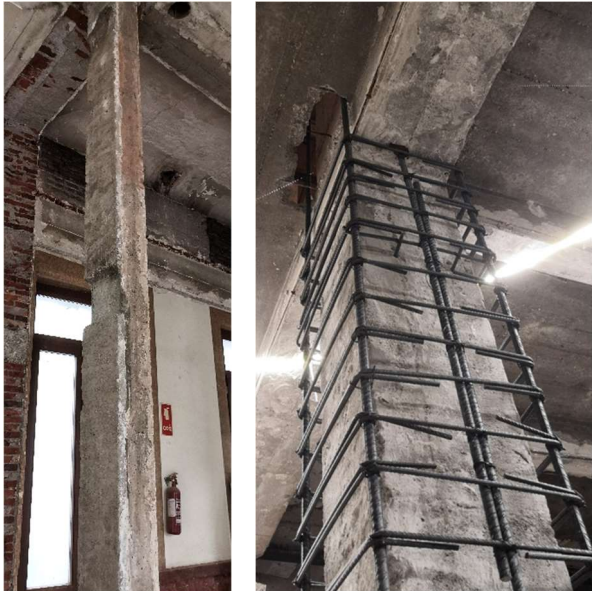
Pilar existente con elevada esbeltez (izda.) y armado del refuerzo de pilares (dcha.).
